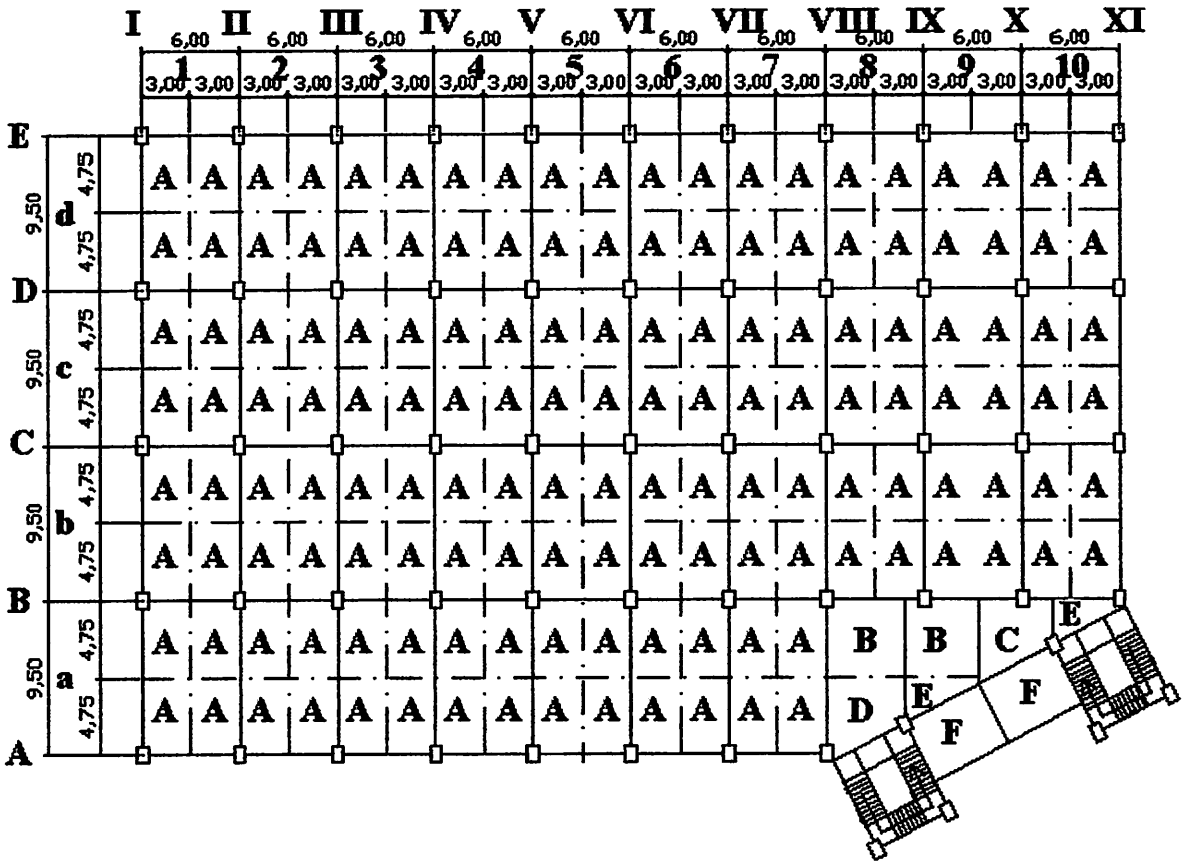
3a Dimensi Balok dan Kolom lantai 1
